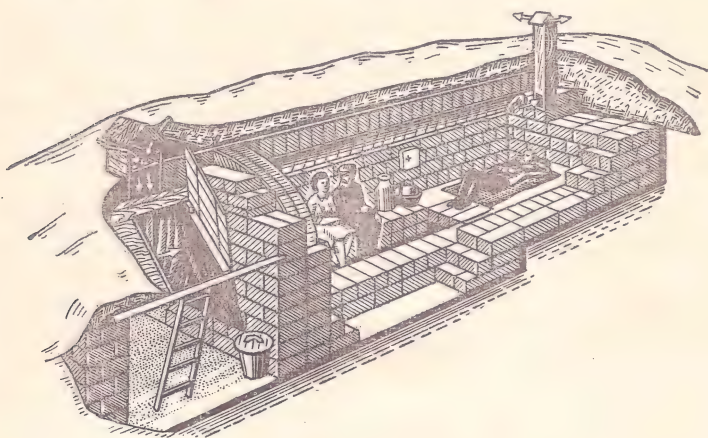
Укрытие со стенами и сводом из саманных блоков (ослабляет действие радиации в 400—700 раз; свод устраивается с помощью передвижной опалубки)
